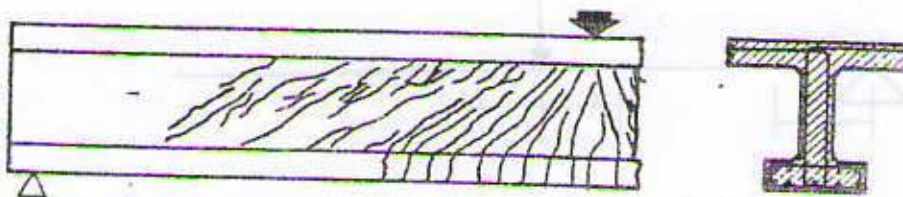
Fissuration d'une poutre sous charge ultime
